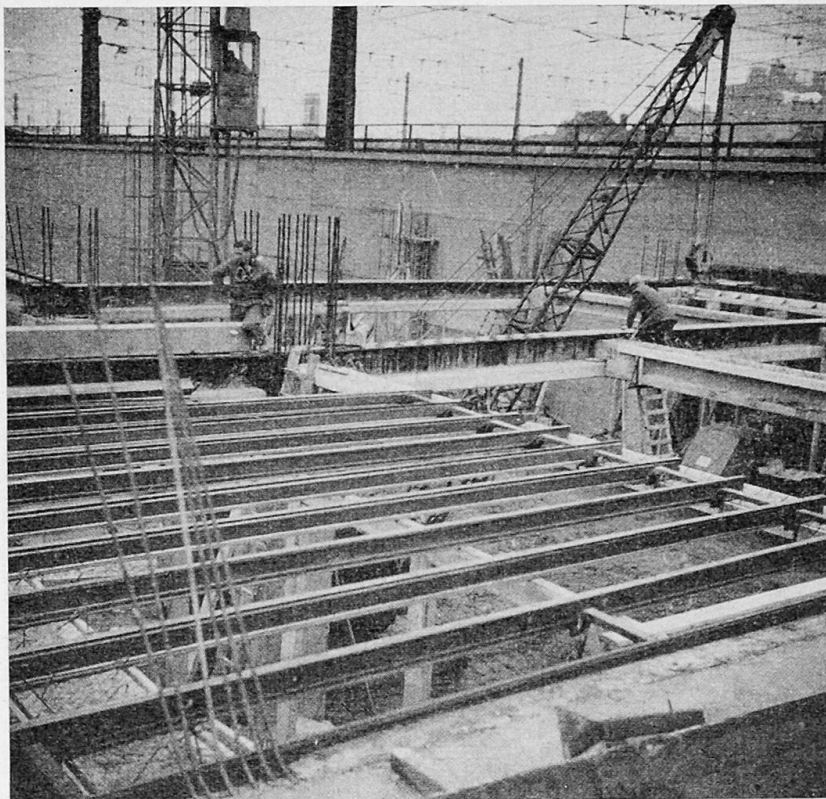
Gare d'Autobus de la Place Rogier à Bruxelles. Doubles cadres avec poutres Préflex de 16 m distants de 8,35 m. Les poutres secondaires sont préfabriquées en béton précontraint. Les nervures métalliques prennent appui sur les poutres secondaires et supportent les coffrages amovibles de la dalle coulée sur place.
